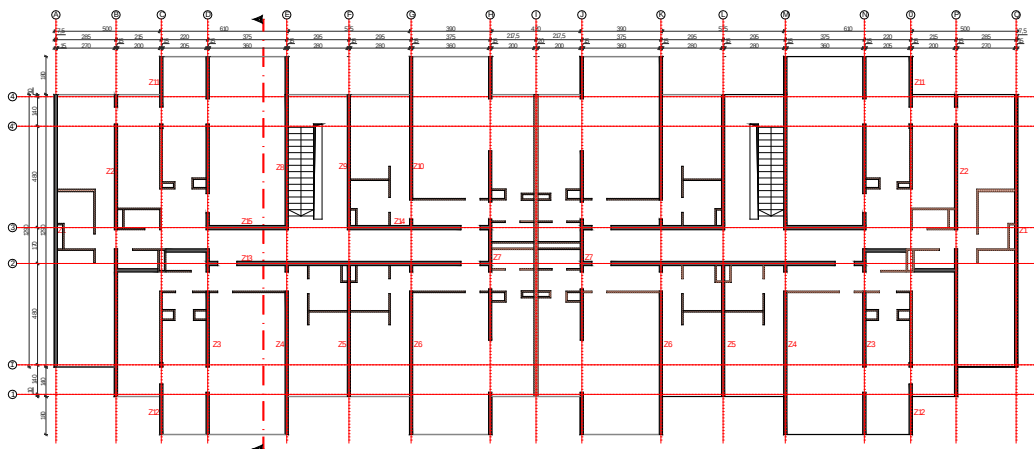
Planimetria e katit karakteristik të ndërtesës U1, RC2H - sistem me mure BA
